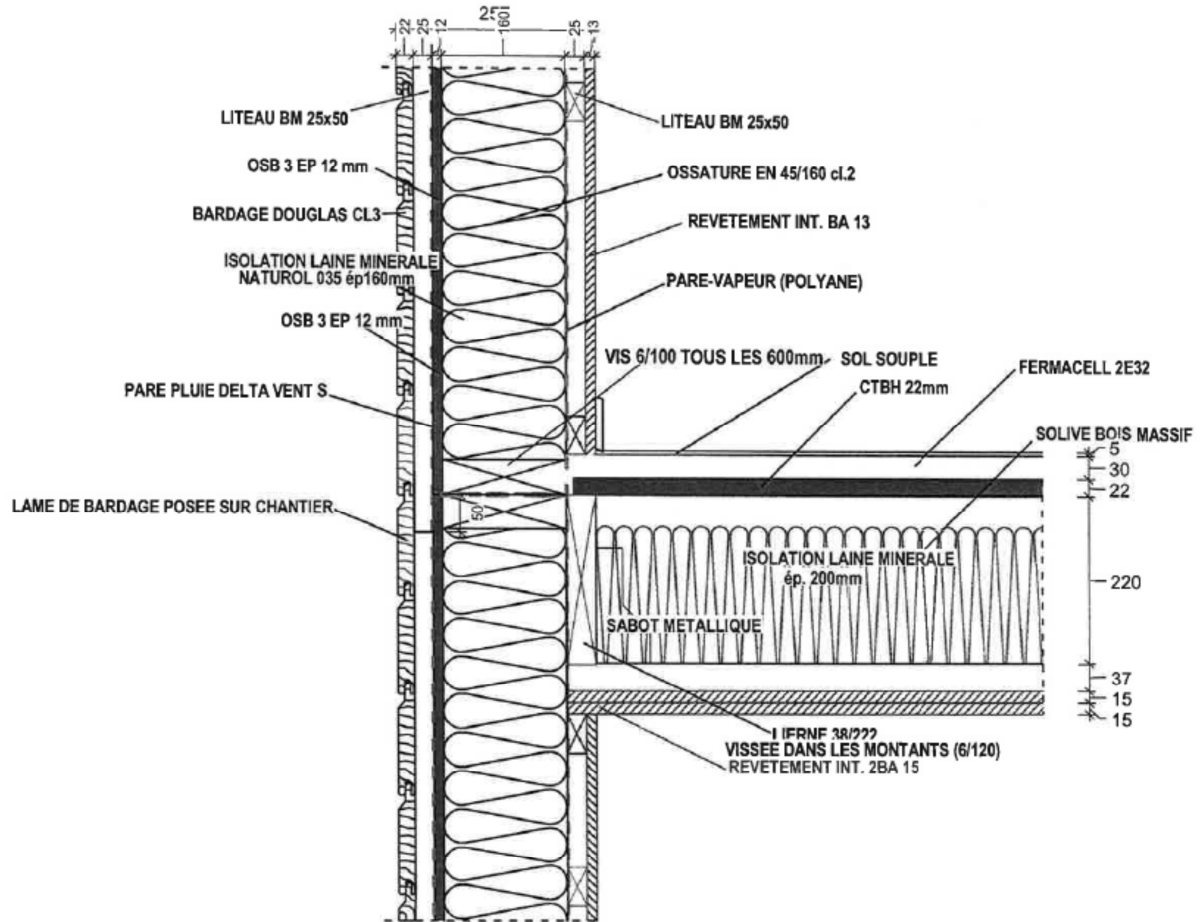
Détail de la jonction en T plancher – façade.
